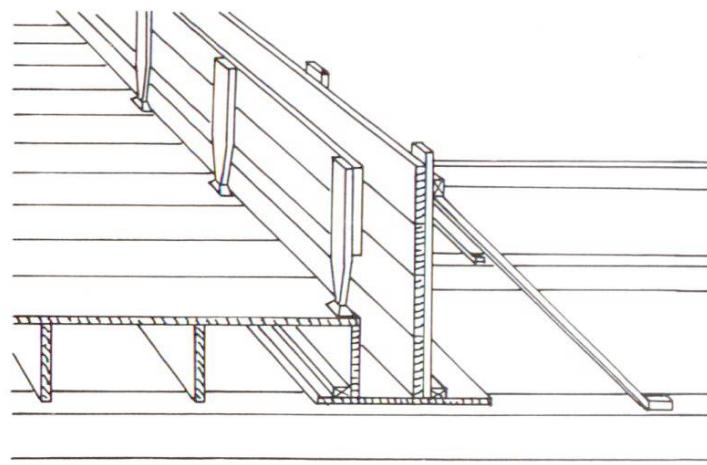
Coffrage d'un bandeau qui doit être bétonné en même temps que la dalle qu'il limite.
